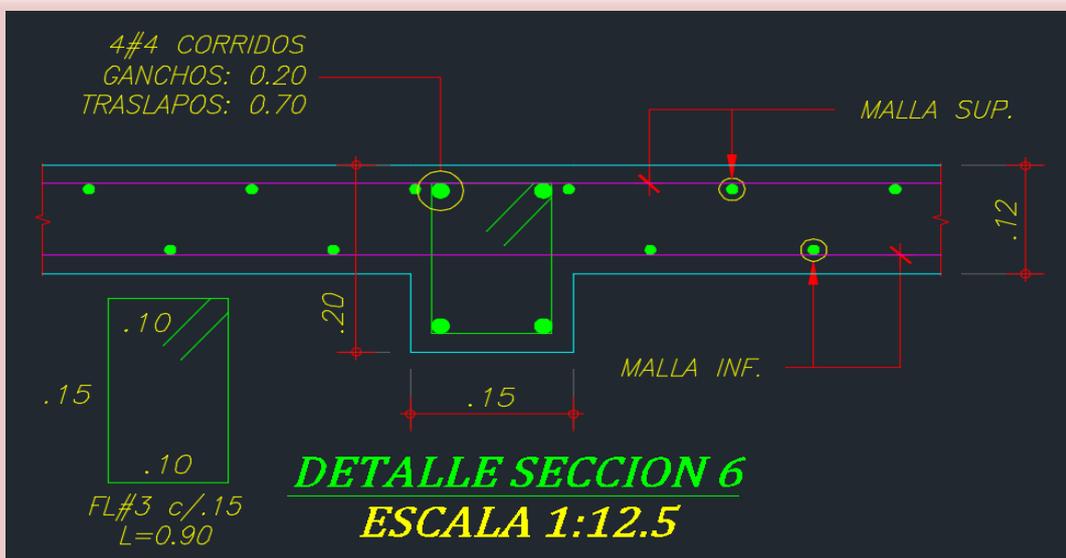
Refuerzo Dintel. Fuente: Planos estructurales.
